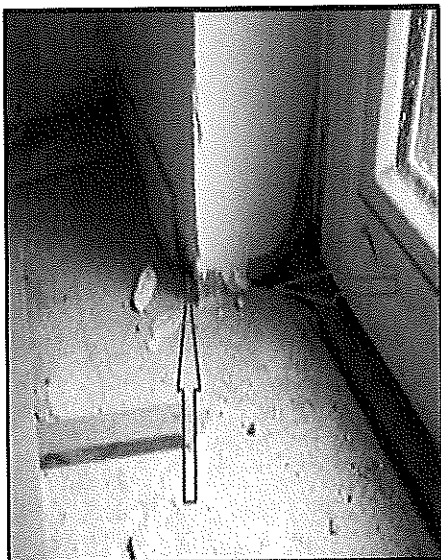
Flux d'air au niveau des liaisons périphériques (parois, plancher) dans le séjour
